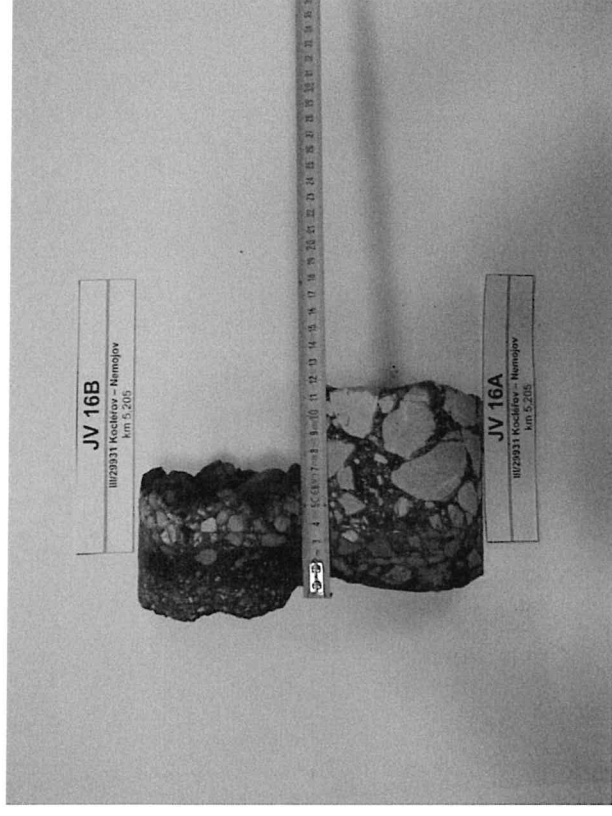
Detail vývrtnů č. 16A + 16B
